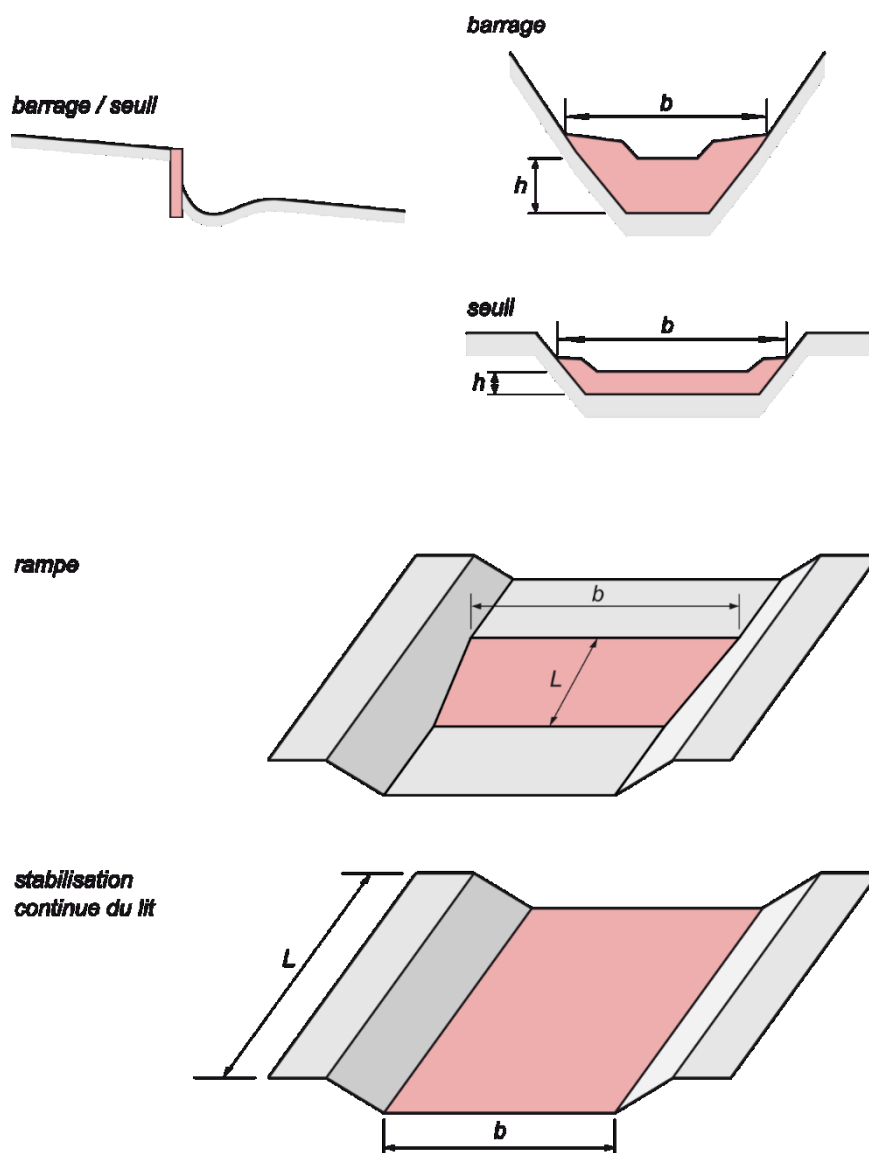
exemples d'ouvrages de stabilisation du lit
